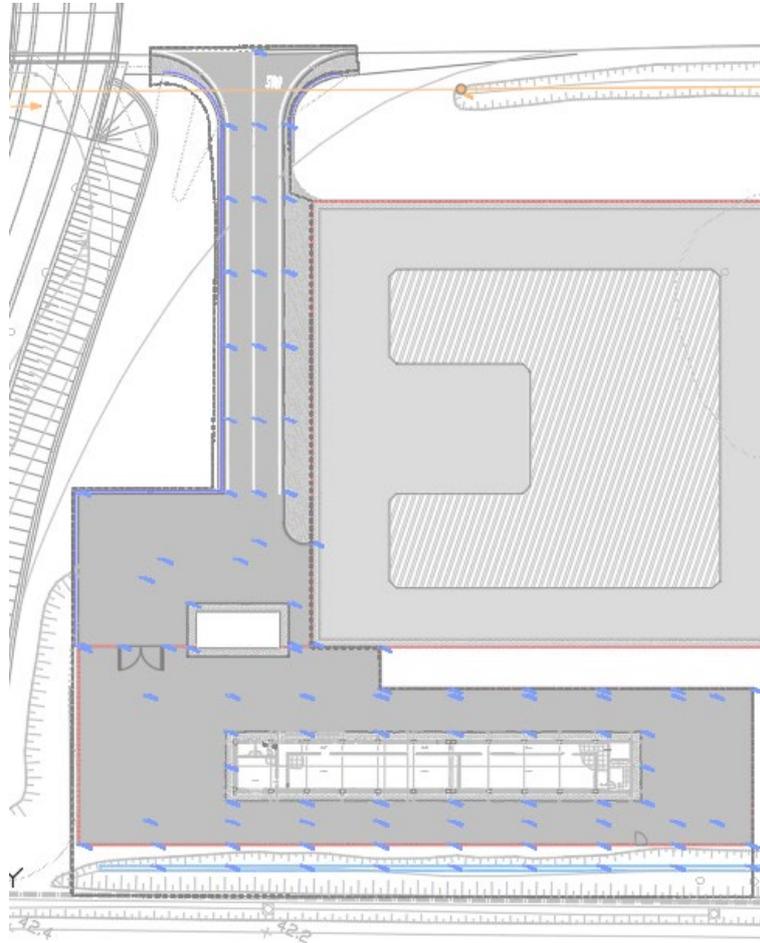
Estratto planimetrico dello stato di progetto – Individuazione dell’area oggetto di intervento con polilinea tratteggiata nera.
